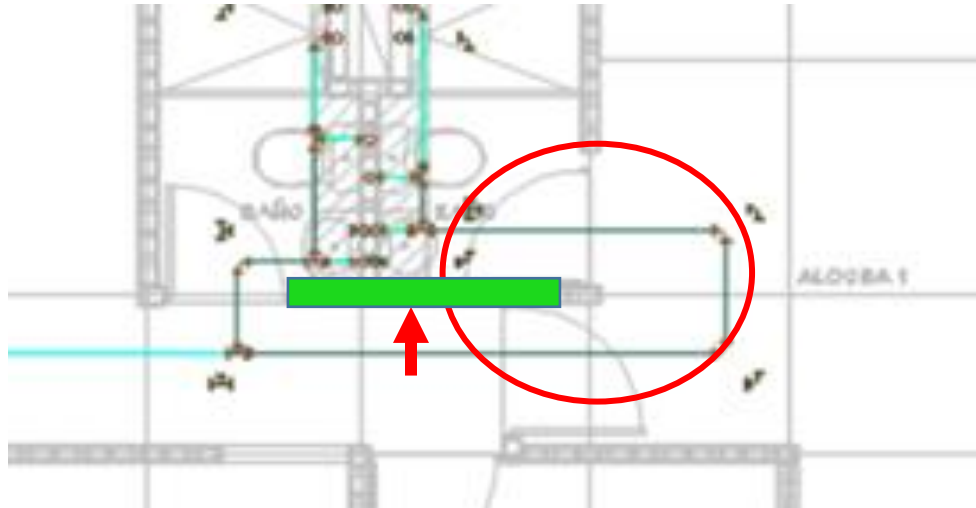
Planta arquitectónica apartamento tipo con red trazada
